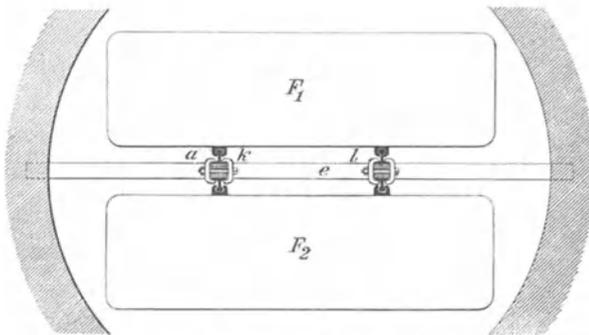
Briartsche Führung mit einem Mitteleinstrich.
